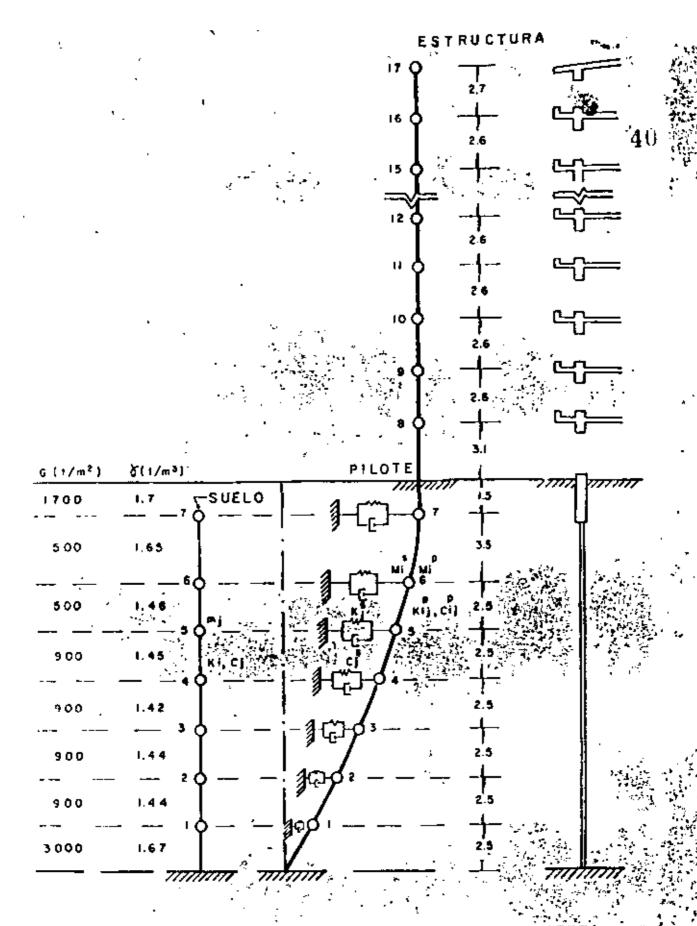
MODELO DEL SISTEMA PILOTE-SUELO-ESTRUCTURA (Ref. 1)
